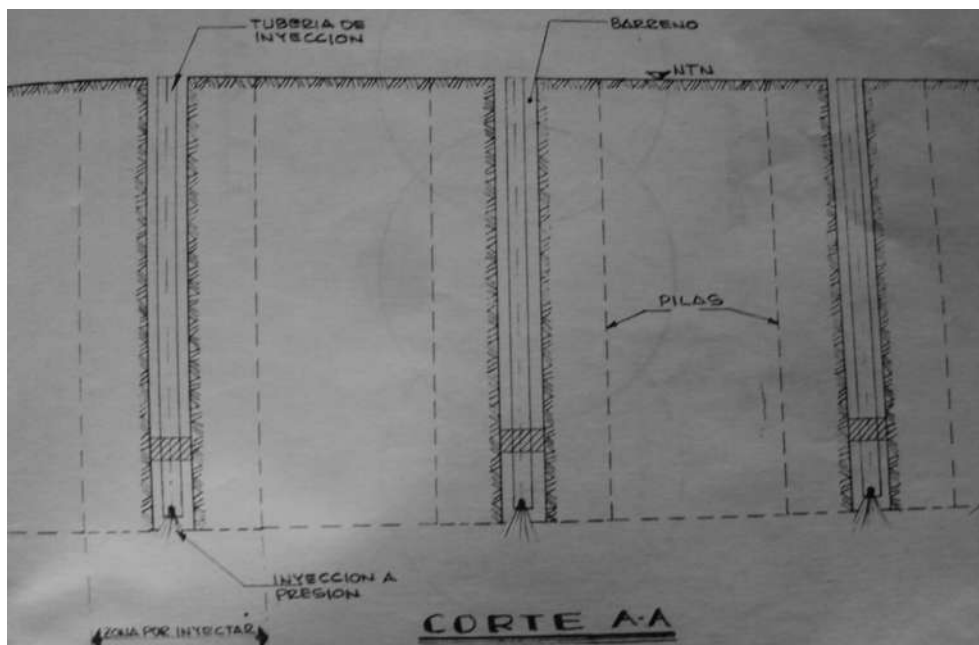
Túnelo falso a base de columnas de suelo inyectadas
